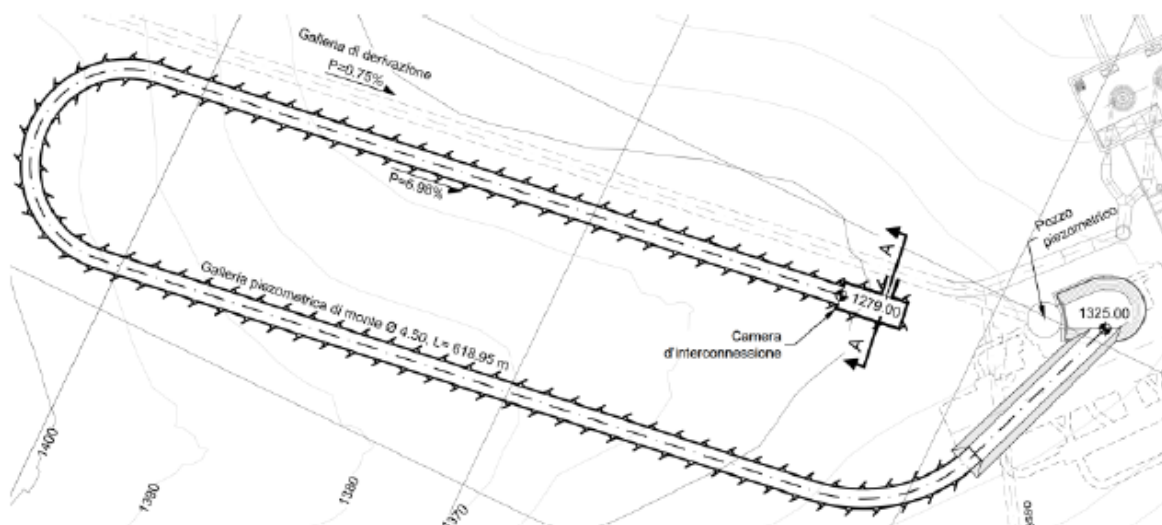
Nuovo pozzo piezometrico sulla derivazione Campotosto - planimetria
